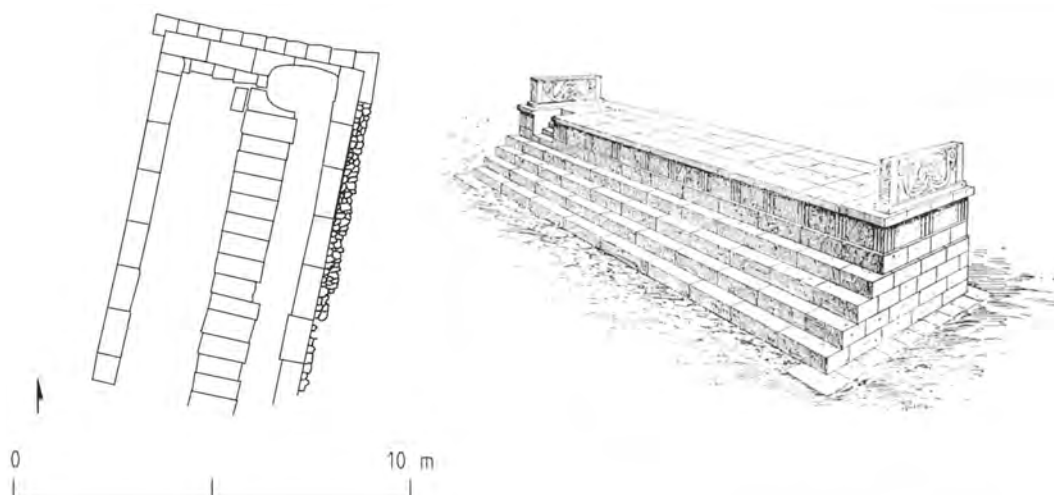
Siracusa, piazza Minerva: altare D, pianta e ricostruzione prospettica.
